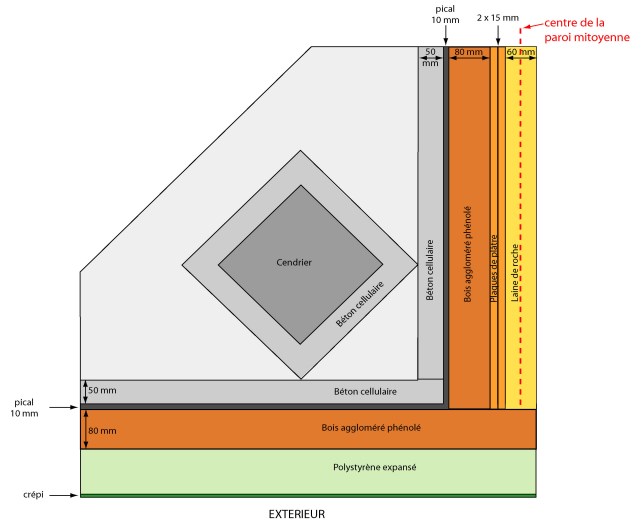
Vue en plan à la hauteur du cendrier, sous le niveau du foyer de la cheminée
